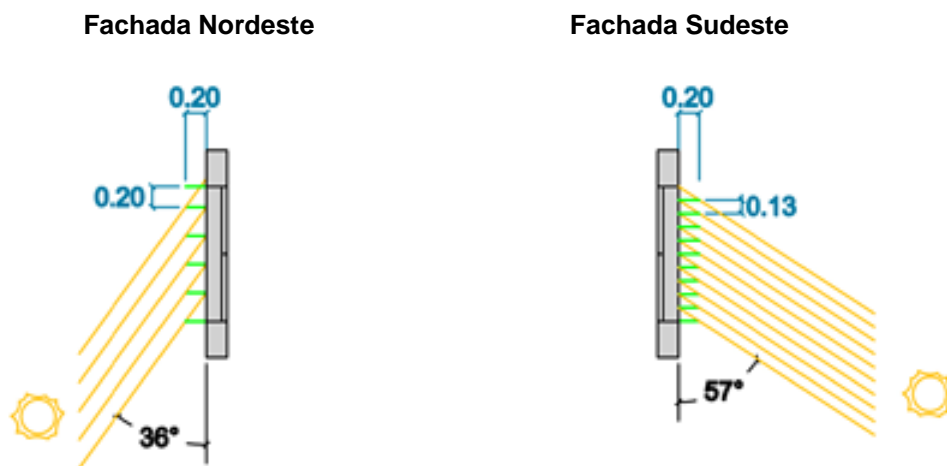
Esquema das palas verticais nos vãos a Noroeste e a Sudeste (vista em planta)
